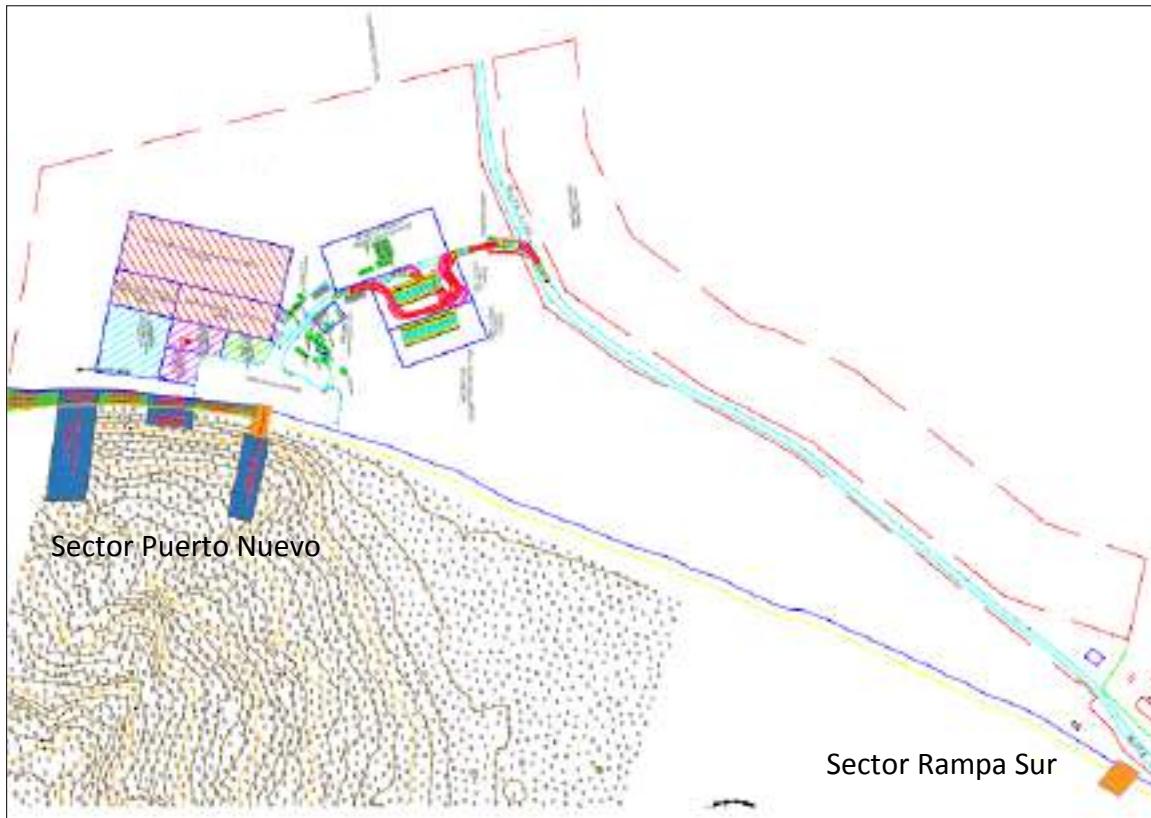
Plan de desarrollo proyecto Puerto Nuevo
